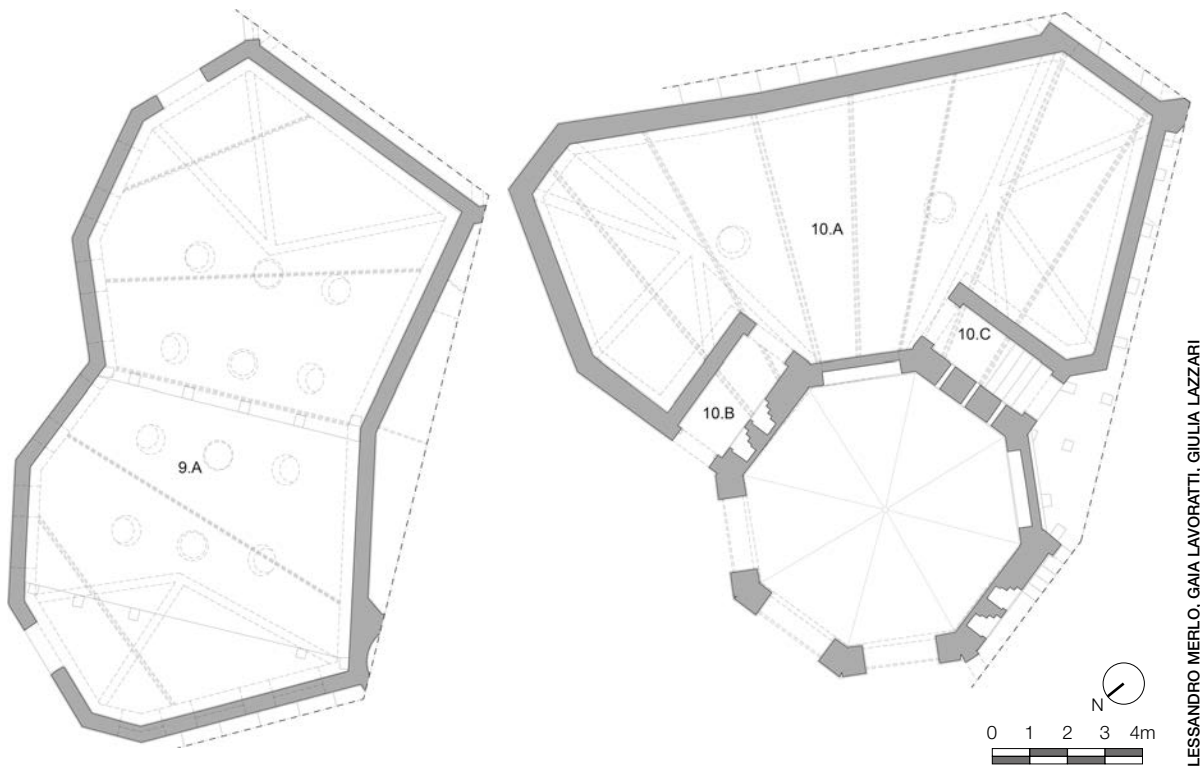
| Planta de los bloques 9 y 10 (escala original de representación 1:50). | Planta del blocco 9 y 10 (escala originaria di rappresentazione 1:50).
